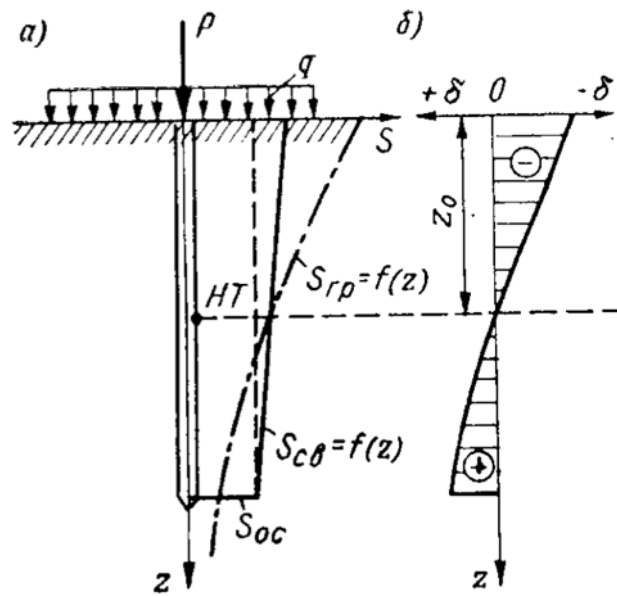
Совместная работа одиночной вертикальной сваи и оседающего грунта: а – эпюры осадок грунта $S_{гр}$ и вертикальных перемещений сваи $S_{св}$; б – эпюры относительных перемещений δ сваи и грунта
